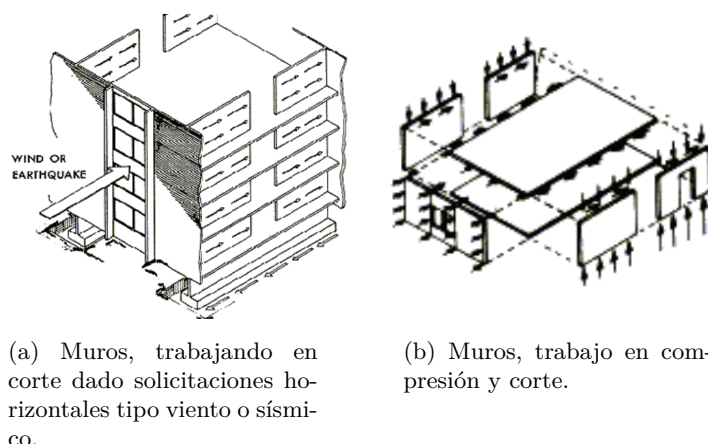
Elemento estructural muro, tipo de trabajo. Ref: Paulay and Priestley, 1992.
